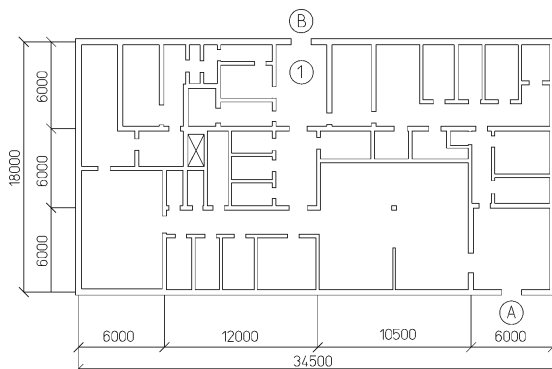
Схема здания: А, В – эвакуационные выходы из здания; 1 – помещение, блокируемое опасными факторами пожара
